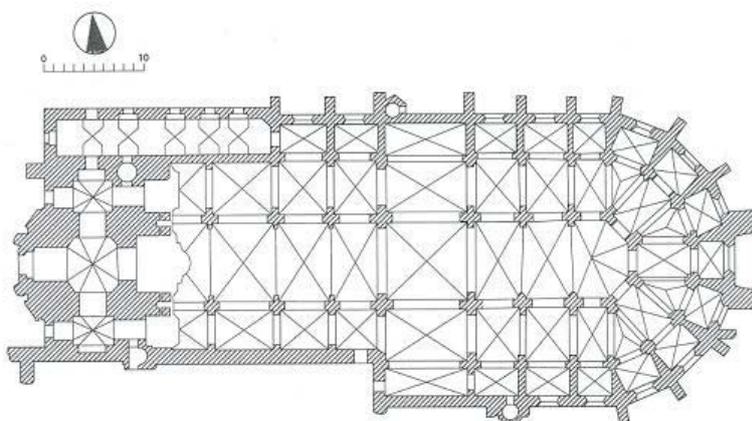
Zwettl, Stiftskirche: Grundriss.
